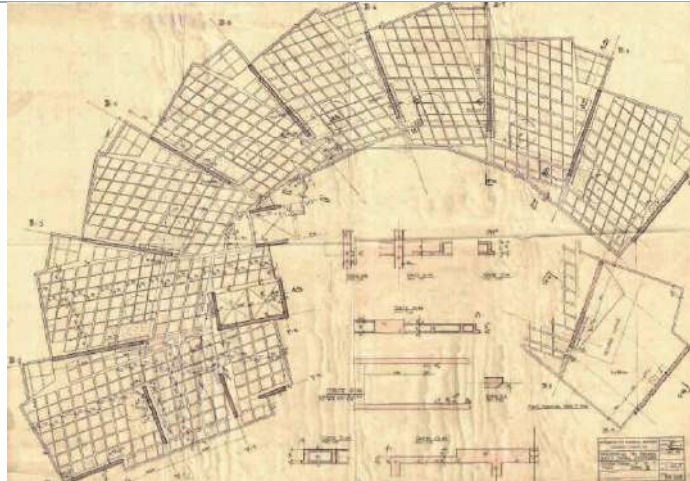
Plano Estructural de las placas con el cálculo del sistema de vigas y viguetas. Fuente: Urrea, T. (2014).
